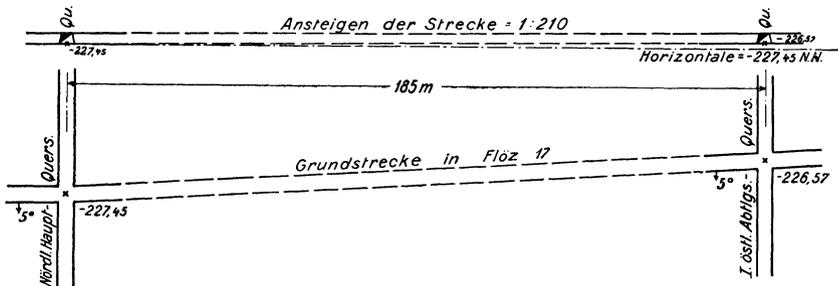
Höhenangabe für den Durchschlag einer Sohlenstrecke; oben Profil, unten Grundriß.
